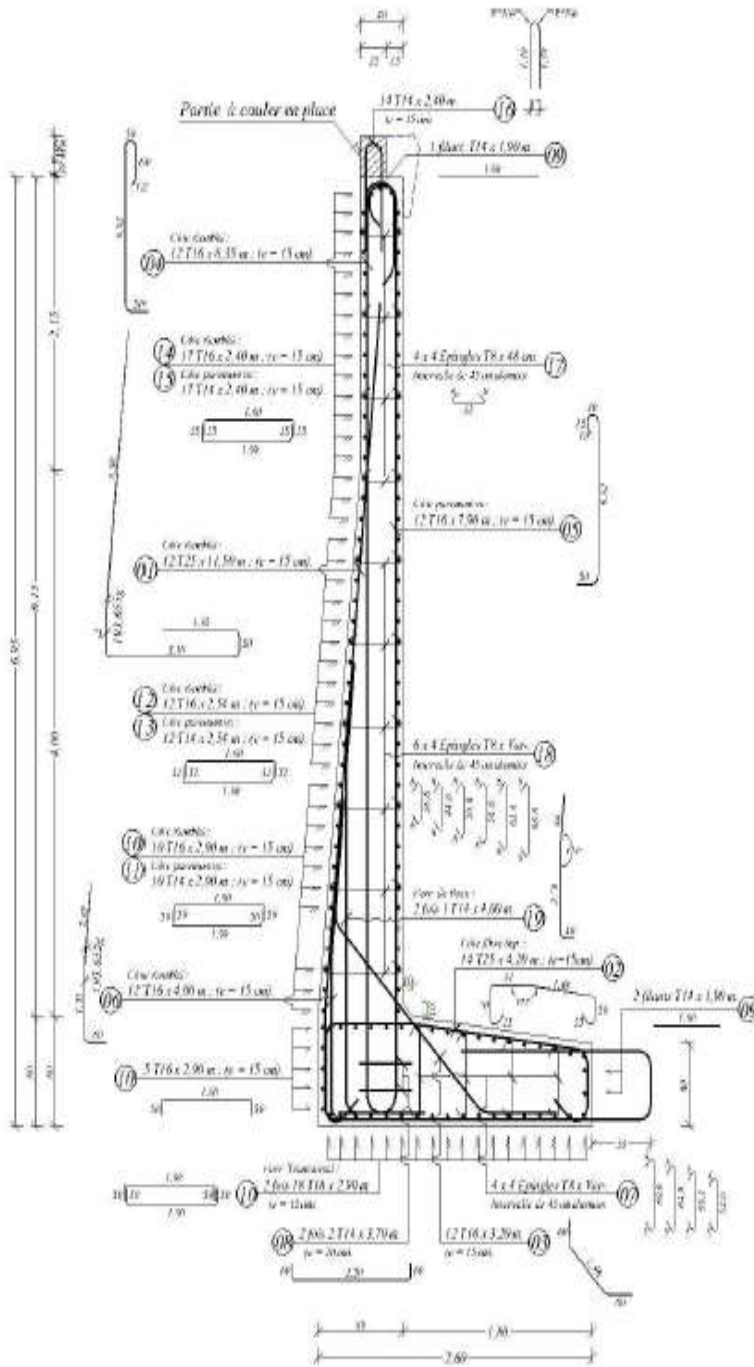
Exemple de ferrailage du mur type « 02 » H=5.24 m
